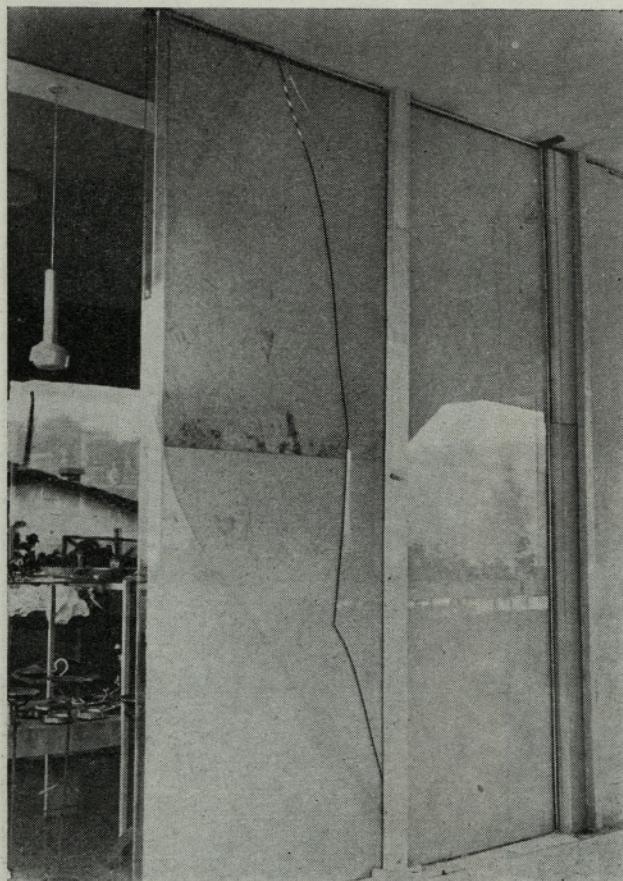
Primer lezenja betonskega zidovja pri visokem objektu
